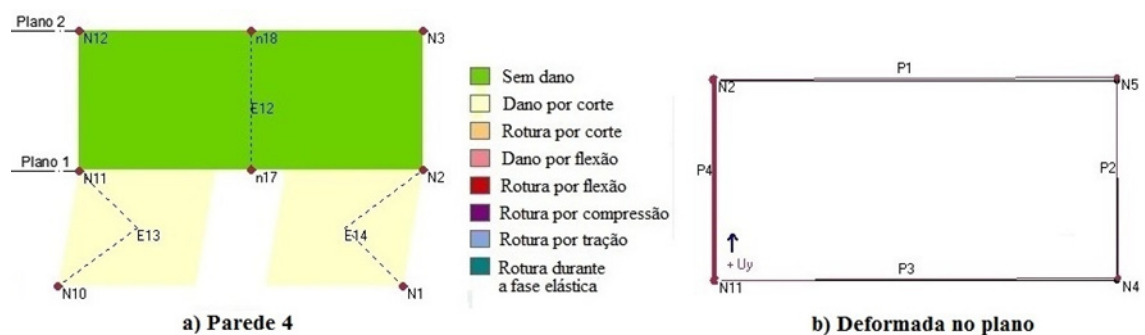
Deformada do modelo M1-Sr: a) em alçado e b) em planta
